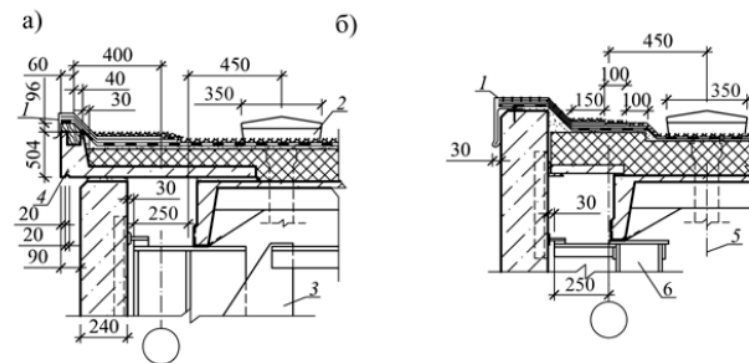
Розрізи покрівлі в поперечному напрямку: 1 – фартух з оцинкованої покрівельної сталі; 2 – ковпак водостічної воронки; 3 – кроквяна ферма; 4 – залізобетонна карнизна плита; 5 – вісь водостоку; 6 – напорна стійка кроквяної ферми.
